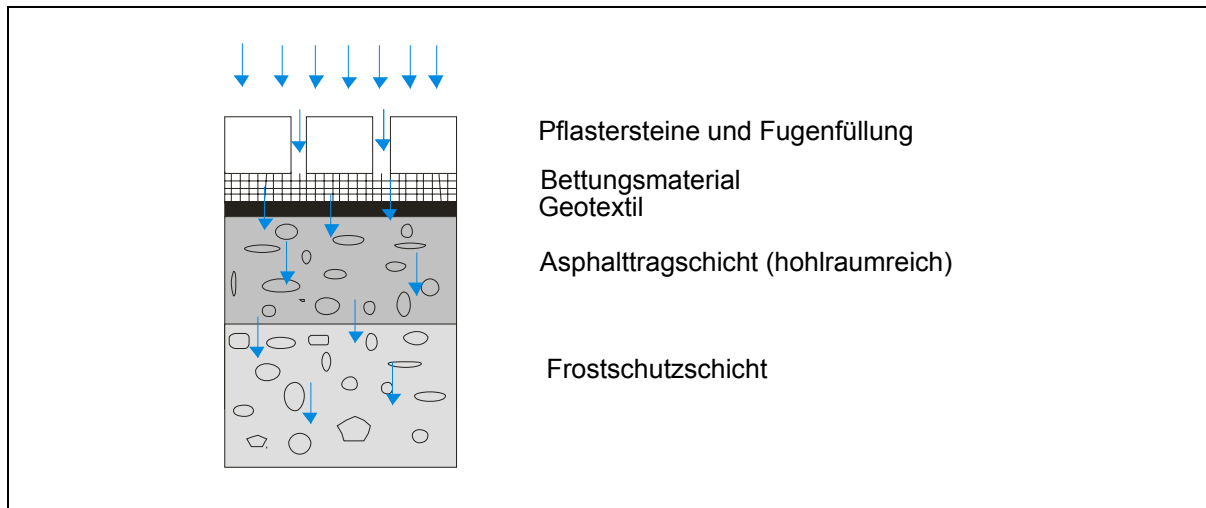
Pflasterdecke mit Geotextil auf hohlraumreicher Asphalttragschicht
